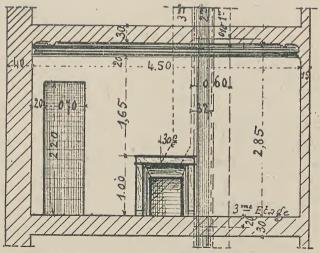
Remplacement d'une poterie dans l'épaisseur d'un mur.
